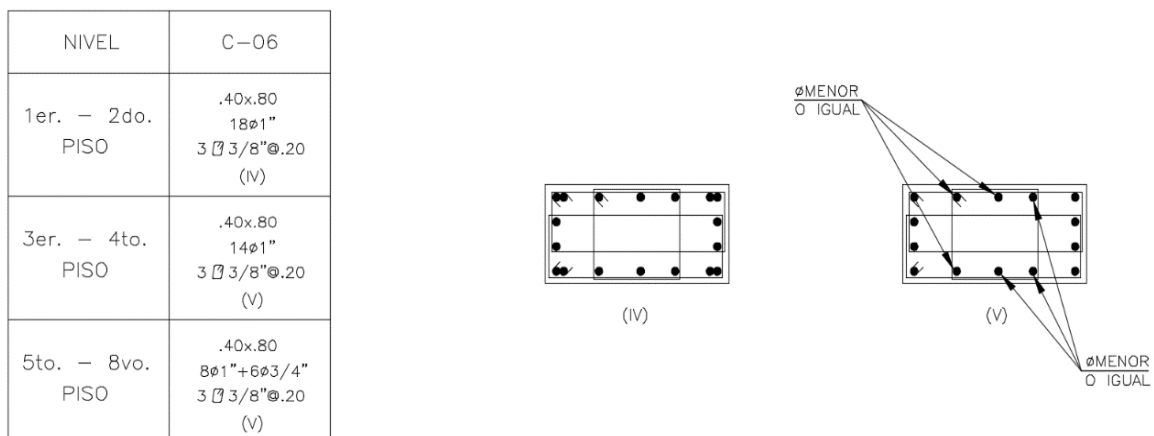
Distribución de acero longitudinal y transversal de la columna C-06
